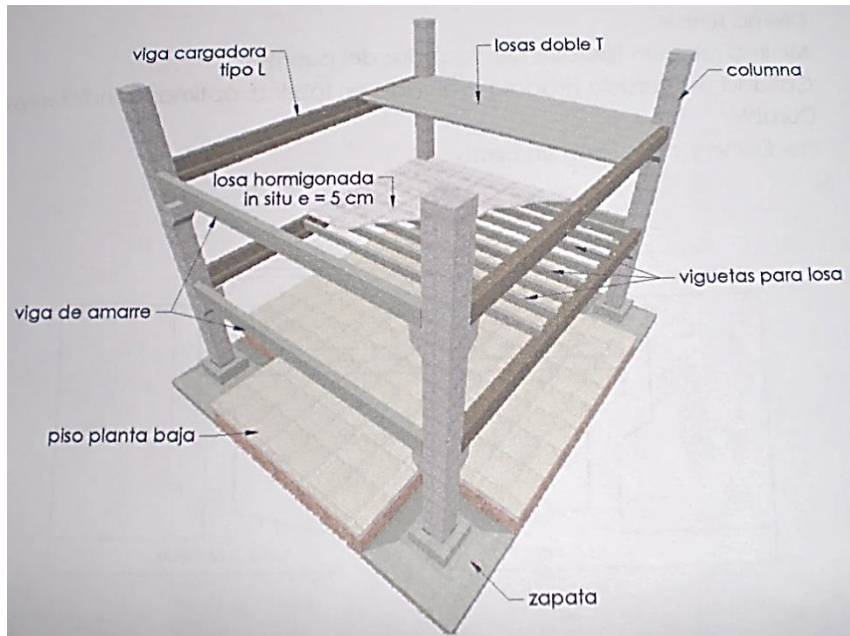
Disposición de elementos prefabricados en la estructura de una edificación. Fuente: Catálogo de soluciones en hormigón prefabricado de la fábrica Carrasco RFV Construcciones.
